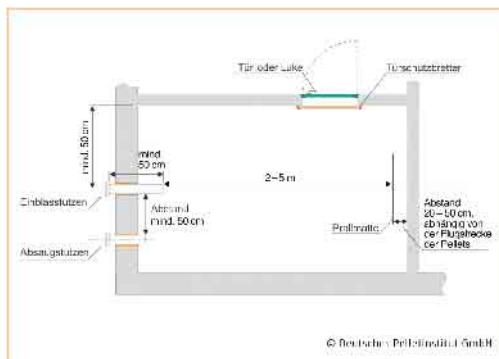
Grundriss eines Pelletlagerraums (Lüftung über Befüllsystem)
